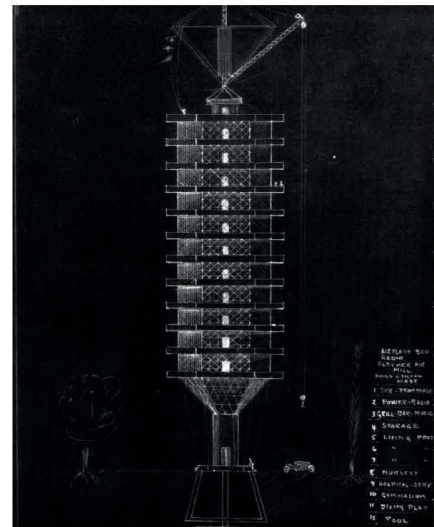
Alzado 4D Tower de doce plantas. Buckminster Fuller, R., 1928
